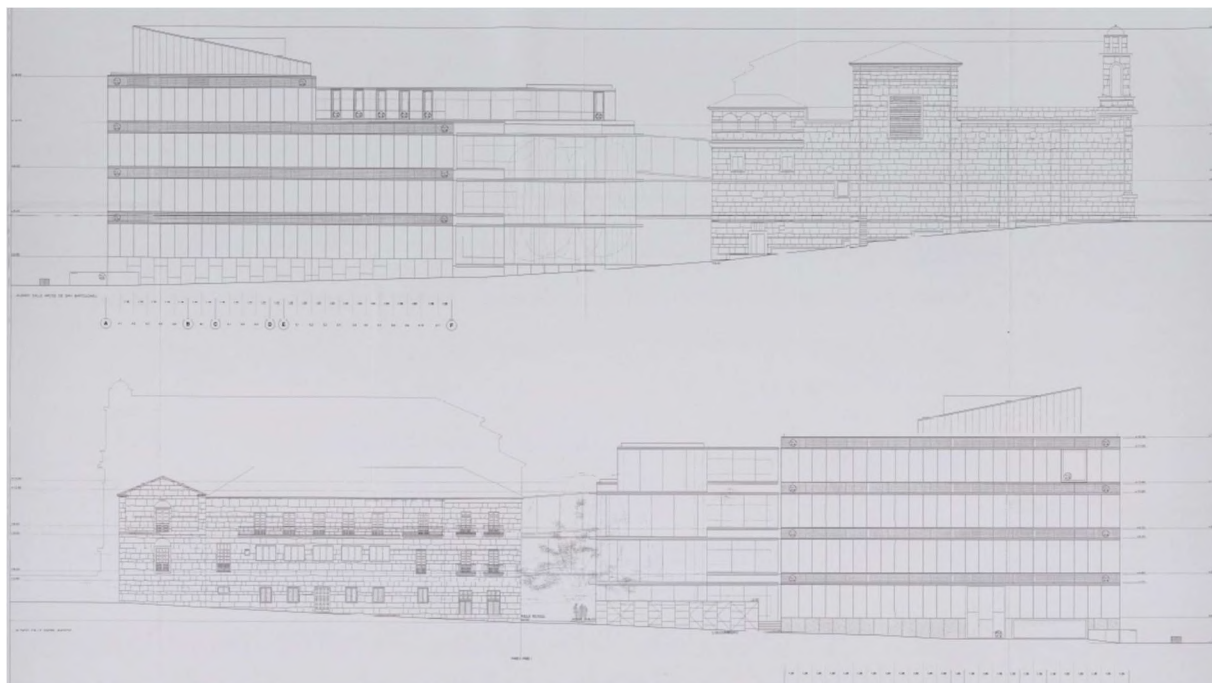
Plano A10: Alzados calle Arcos y Padre Amoedo.
